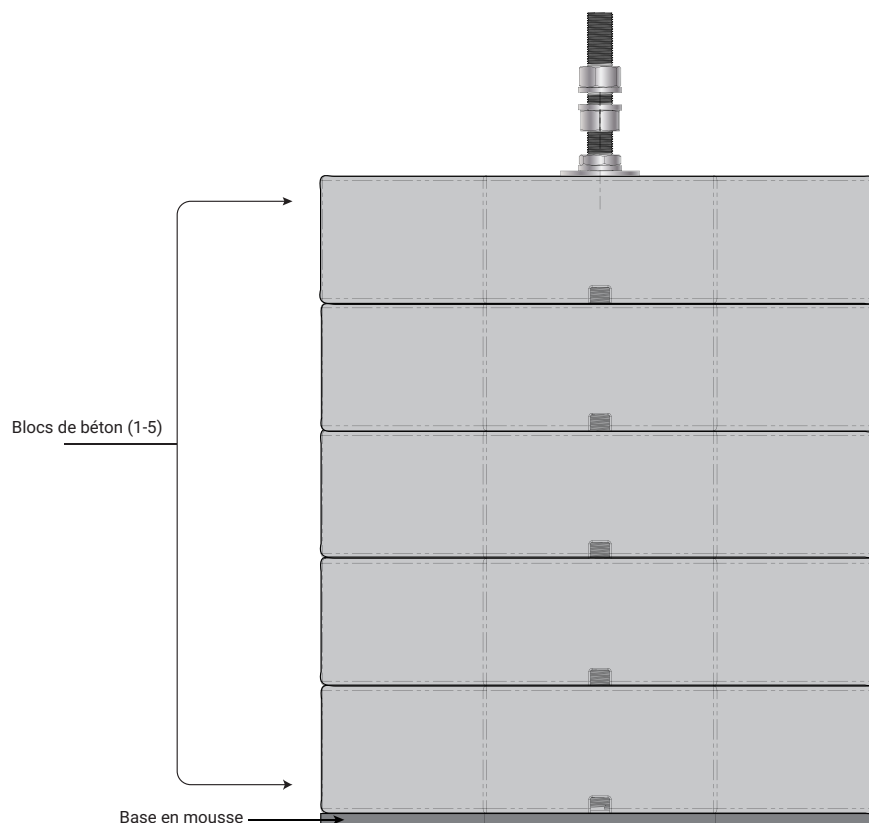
Pile de blocs de béton pour socle de mât sur une surface horizontale
